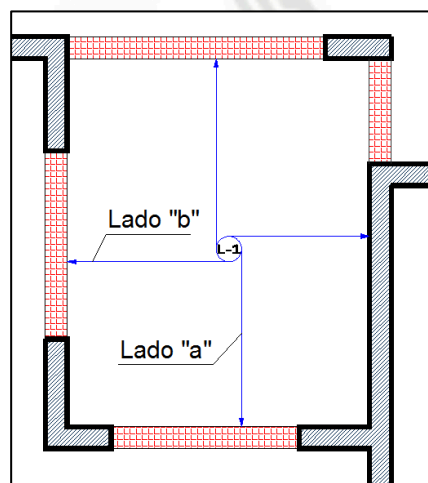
Losa de cimentación (Paño 1).
